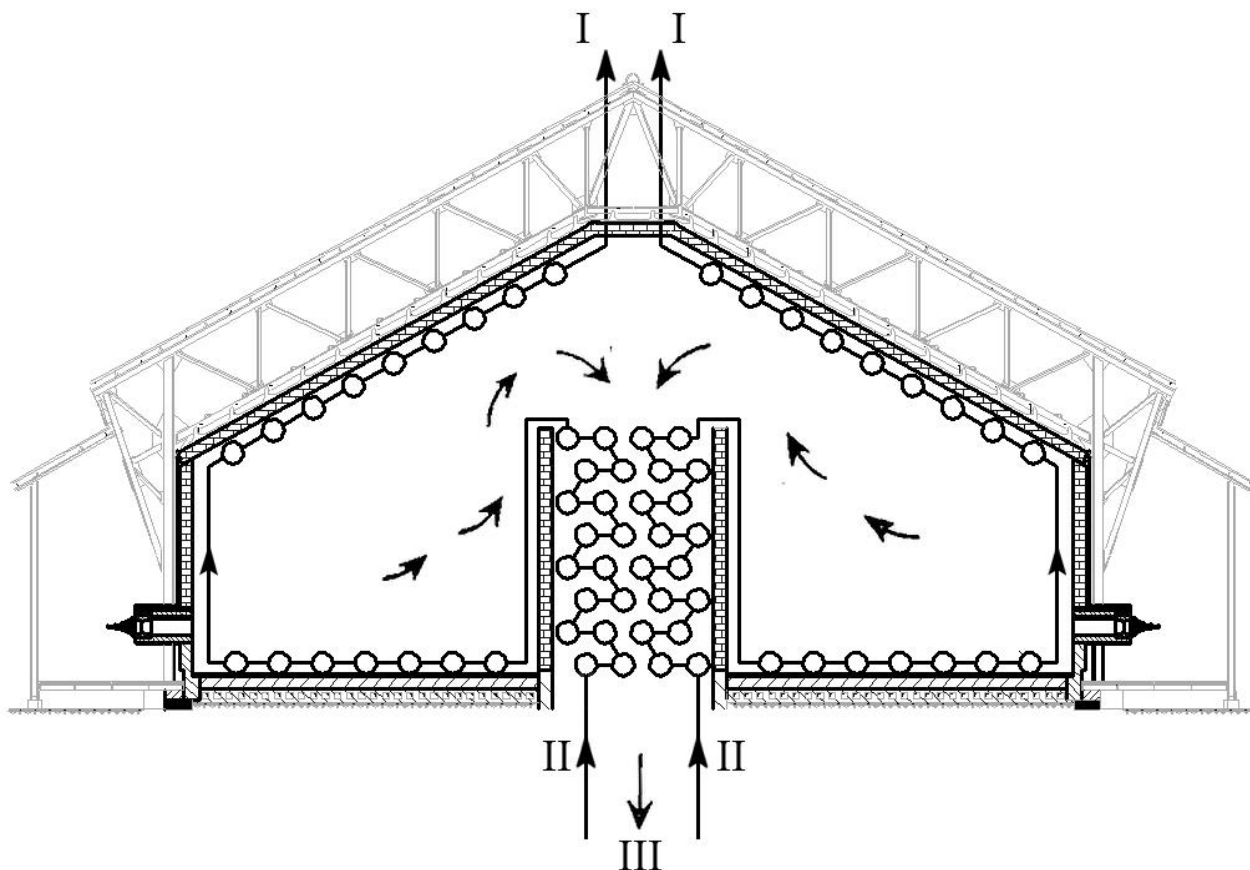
Двухкамерная трубчатая печь шатрового типа
